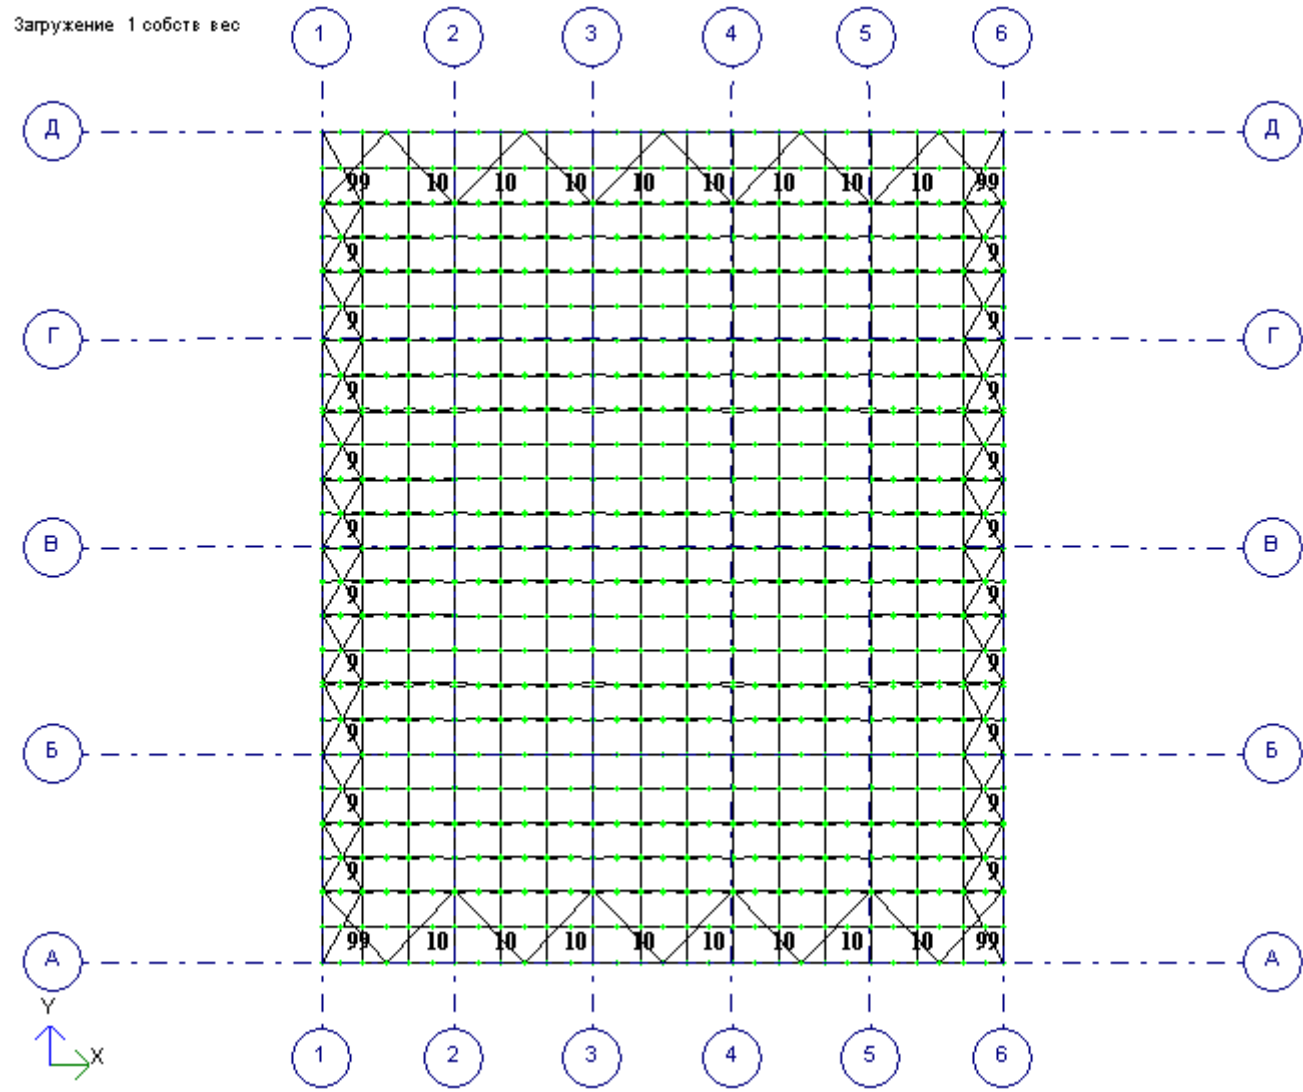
Схема зв'язків по нижньому поясу ферм
